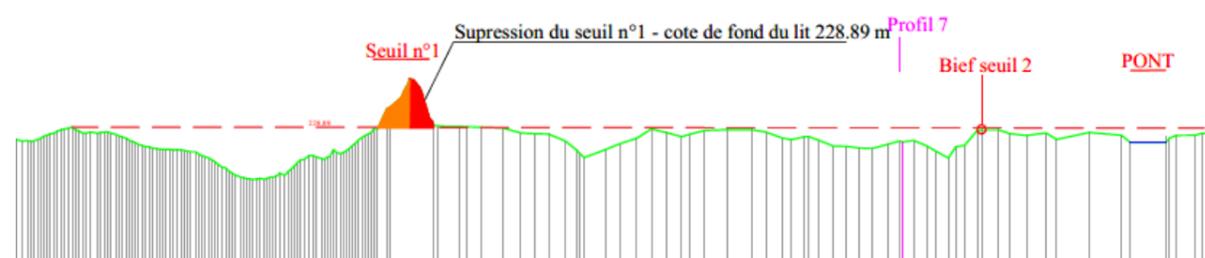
Extrait profil en long du Madon au droit du seuil 1
